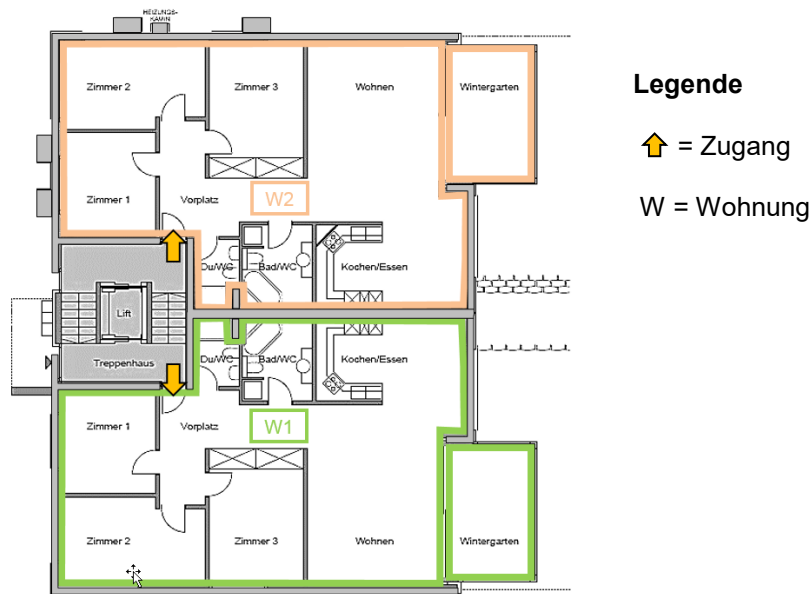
Die Bestandteile bei einer Stockwerkbegründung auf dem Stammgrundstück 2525
